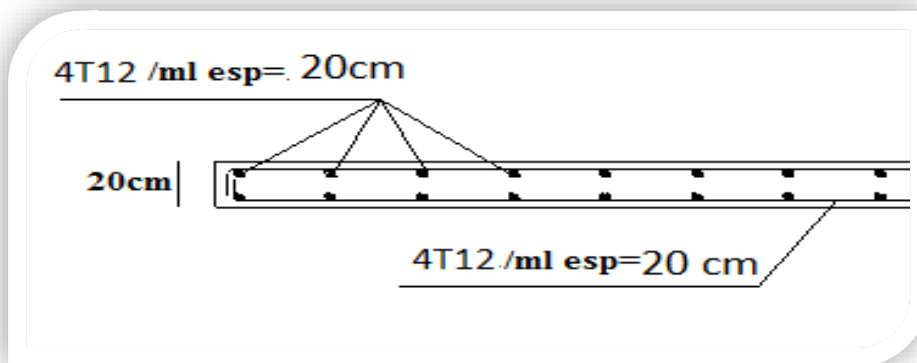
Ferrailage de la dalle pleine du So-soul
